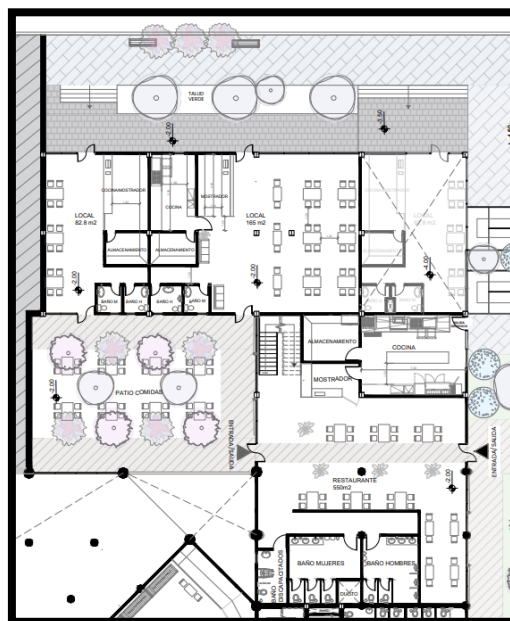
Planta Locales Nivel -2.00 Ramires S 2023
